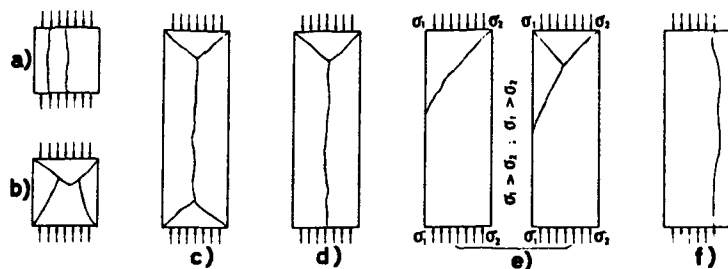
Grietas típicas en cubos y prismas de sección cuadrada, ensayados a la compresión, según Jolsel (citado por Bukowski¹).
